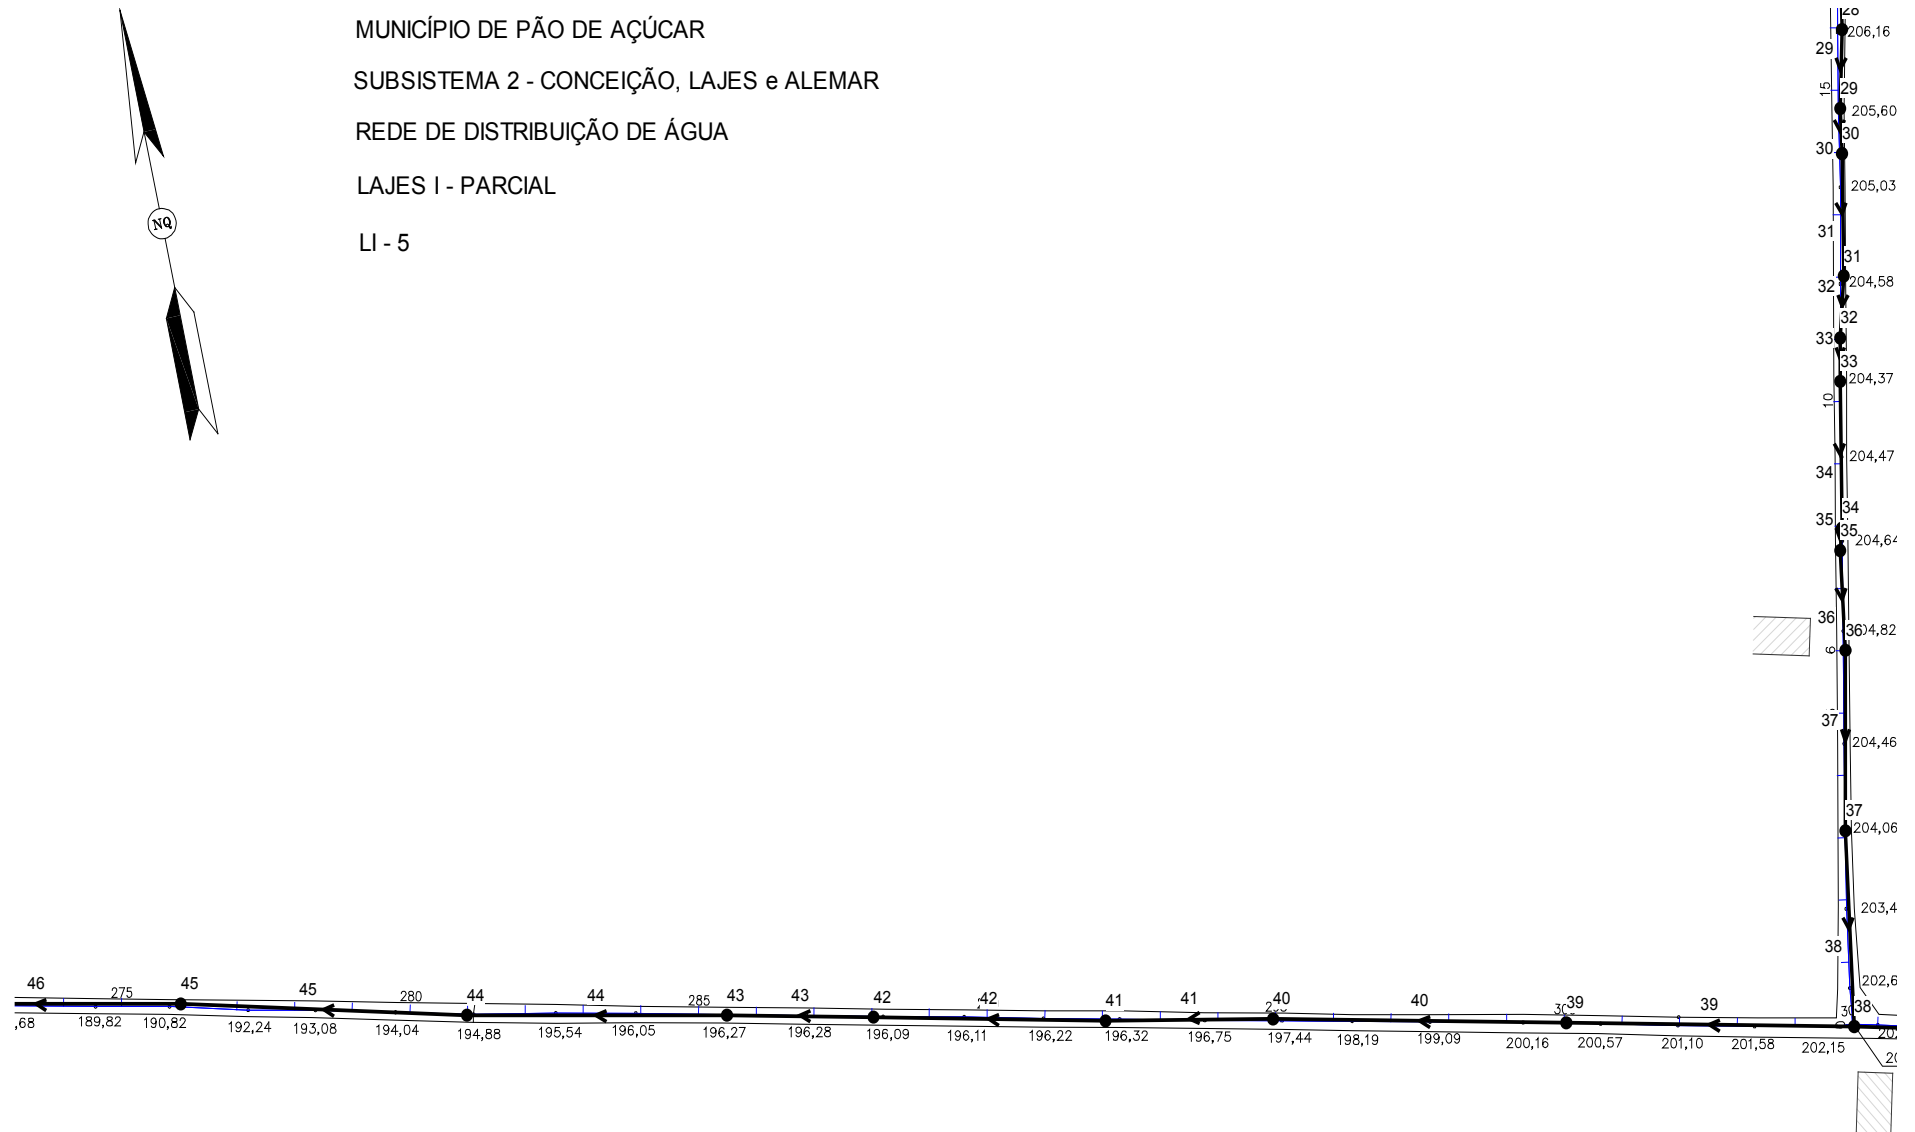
EPANET parcial 6 – Rede de Lajes 1
